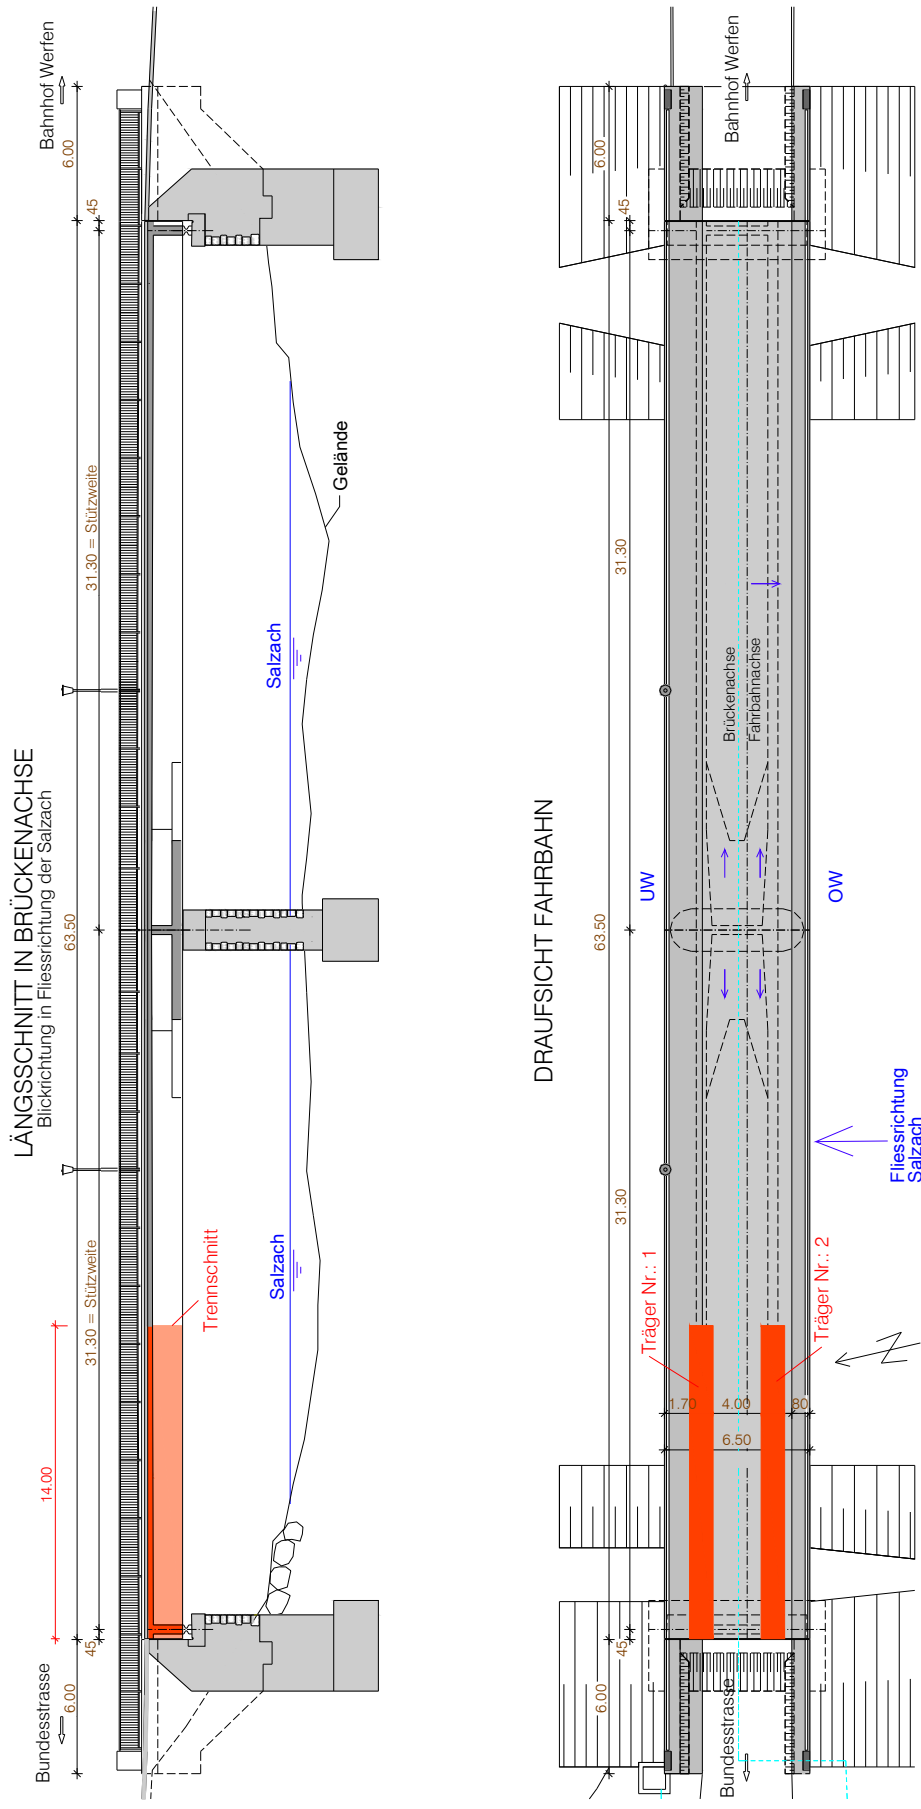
Bestandsplan der Brücke und Lage der Träger
